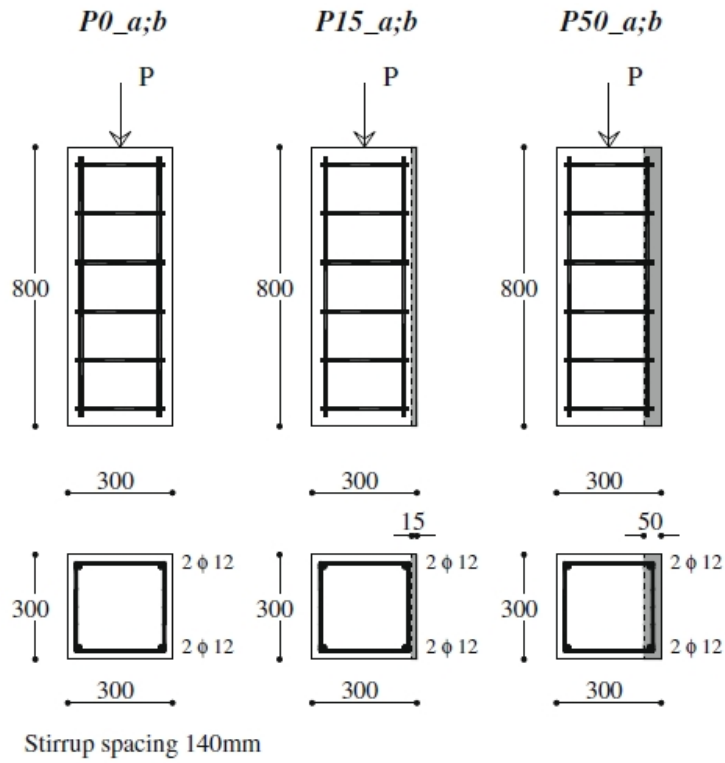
Geometría y características de los pilares ensayados, Pellegrino et al. (2009).
